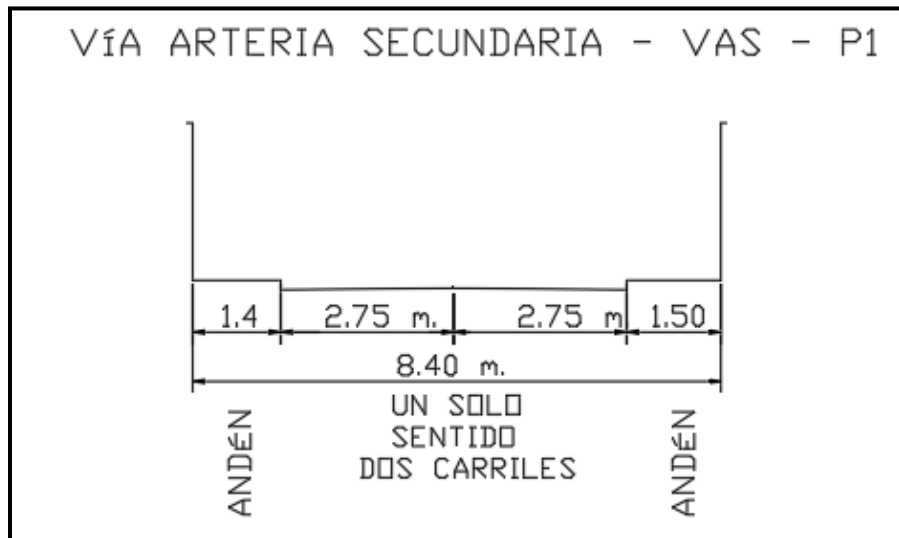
Sección vial 4-4'. Fuente: Elaboración propia.
